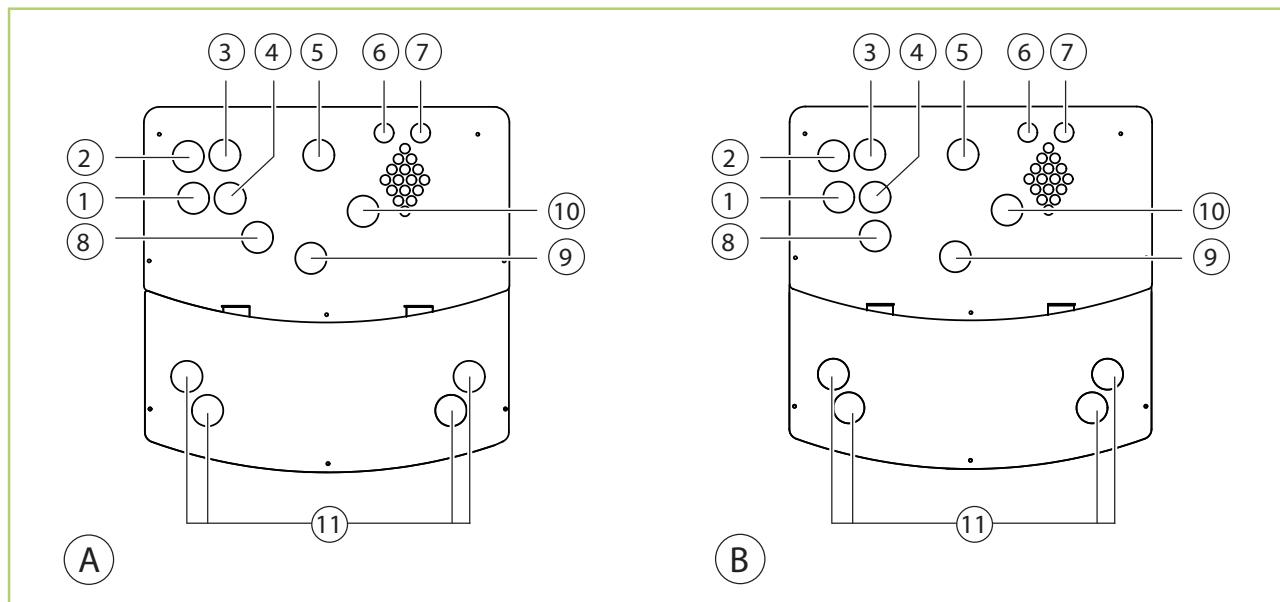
Bezeichnungen der Rohranschlüsse WKF-compact 85/120/180
